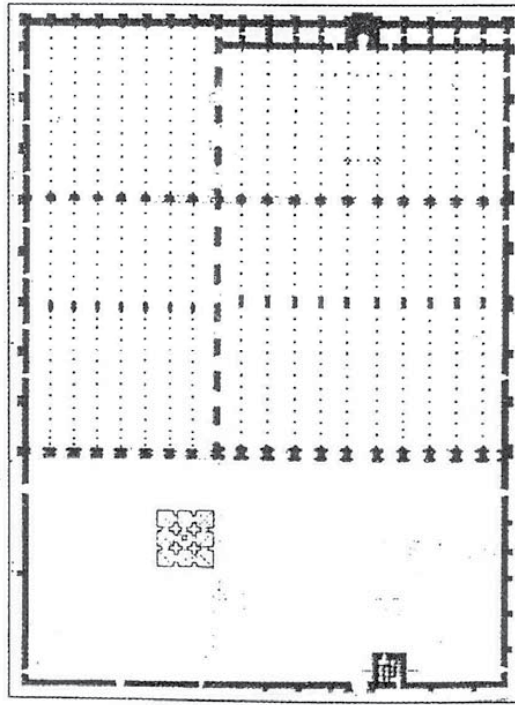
الجامع الأعظم بتلمسان، مسقط أفقي، عن:
